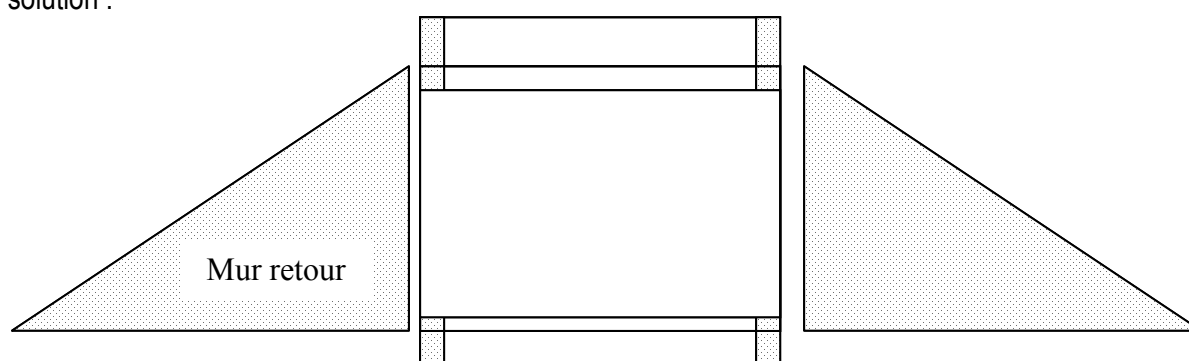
schéma de la voûte avec murs en retour (coupe transversale)
